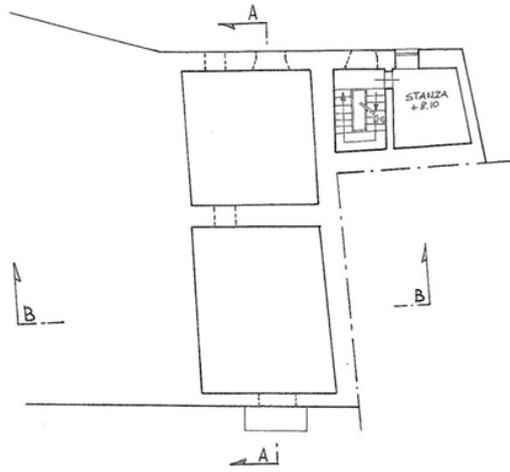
Planimetría orientada del sitio donde está ubicada la sinagoga
